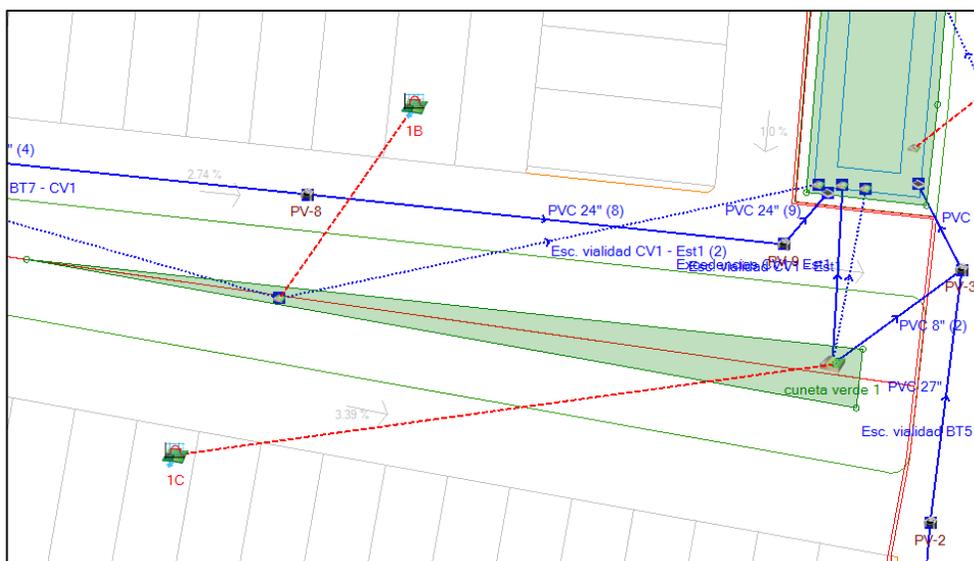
Vista en planta de cuneta verde 1 y sus conexiones. Fuente: xpdrainage.
